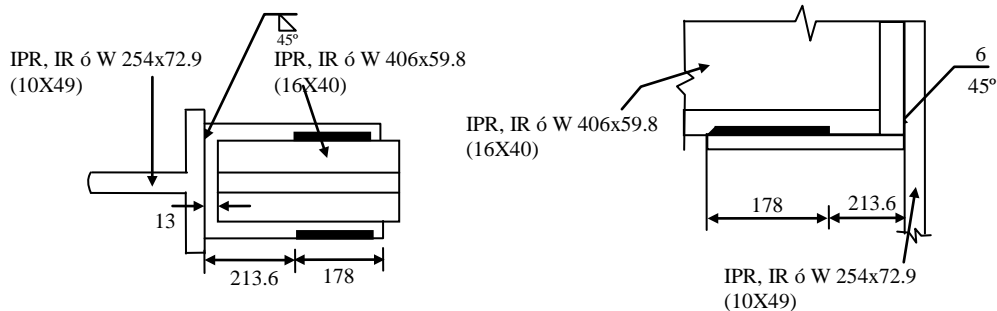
Disposición de soldadura, acotaciones en mm.
